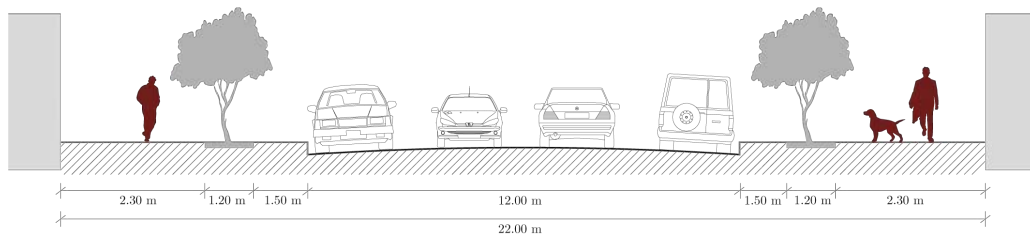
Sección de la calle local Sterling Place. Elaboración: Propia
